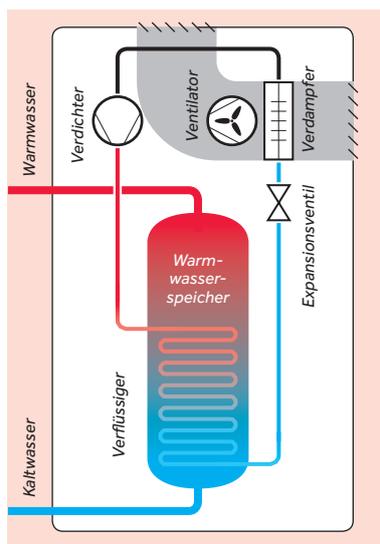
Prinzipdarstellung einer Warmwasser-Wärmepumpe
